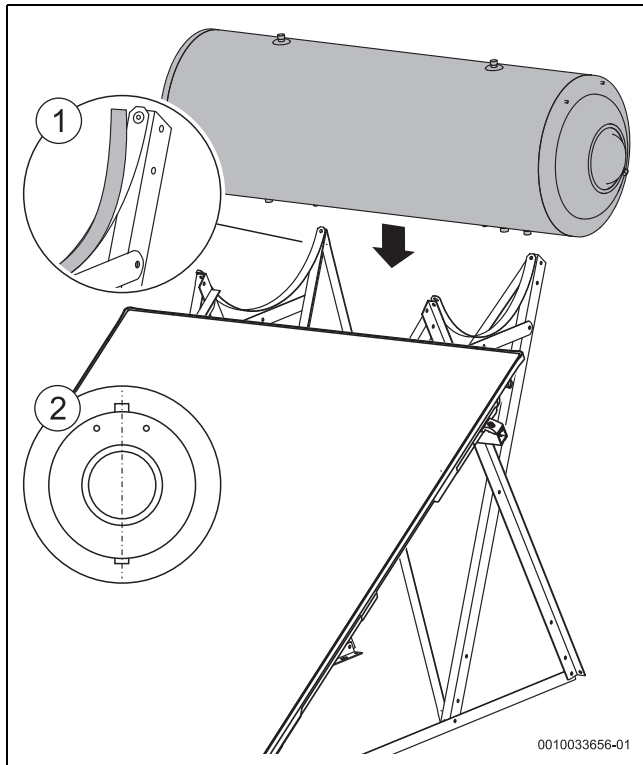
Colocar o acumulador sobre a estrutura para telhado plano e alinhar
